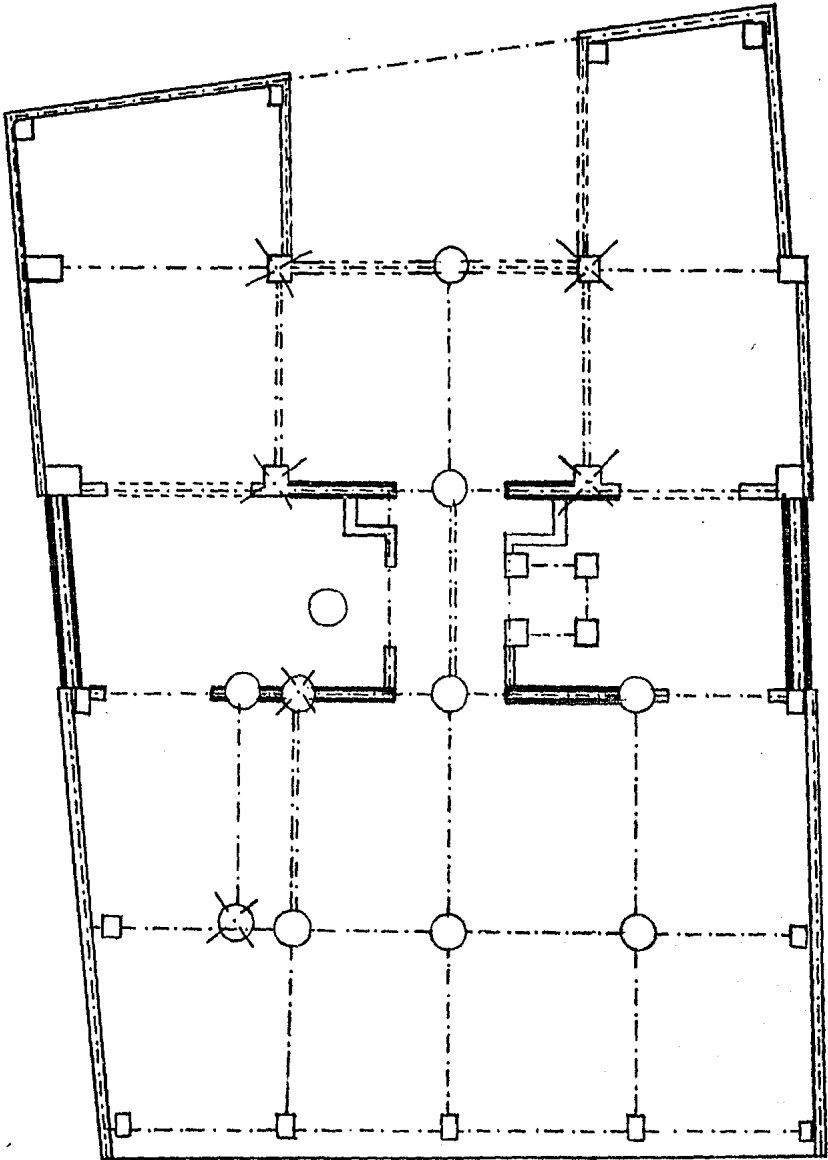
Refuerzo y reestructuración, soluciones A y B,
